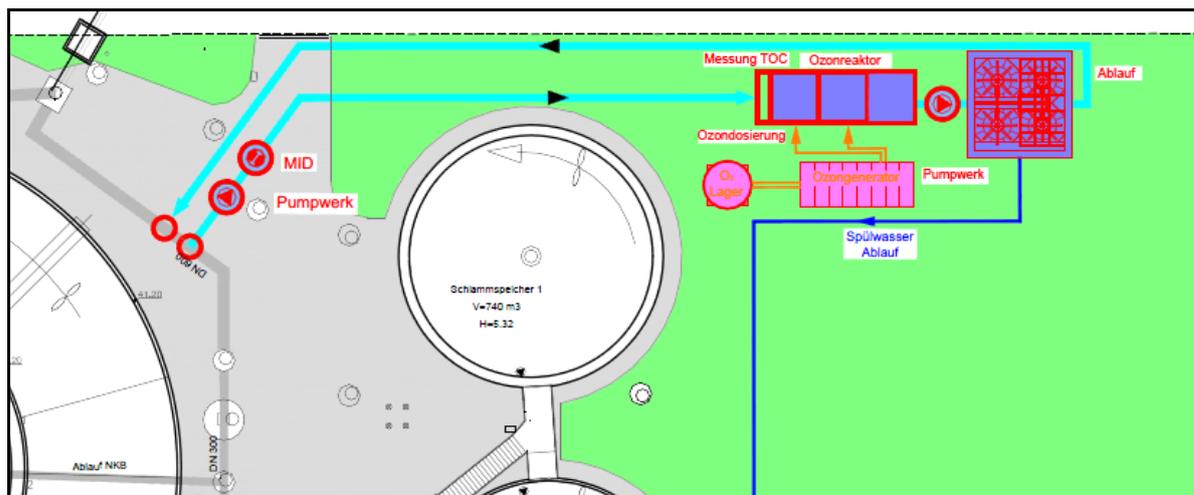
Lageplan KA Rahden - Variante 3.2 – Ozonung mit nachgeschalteter Dyna-Sand Filtration
